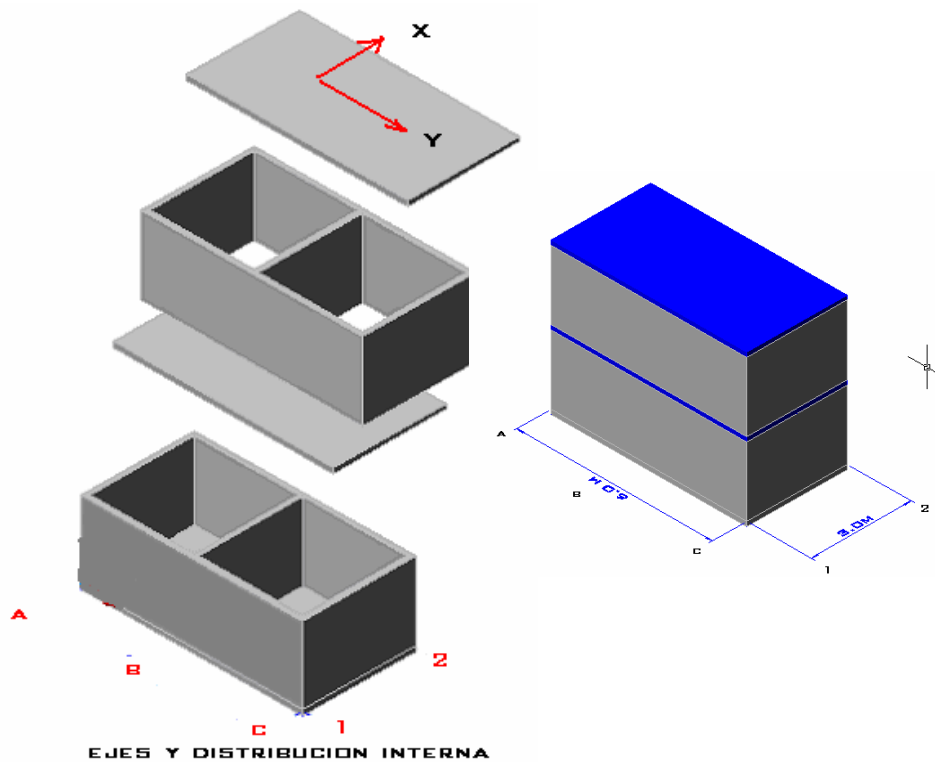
B. DISTRIBUCION INTERNA DE MUROS Y EJES ESTRUCTURA DE EJEMPLO.
